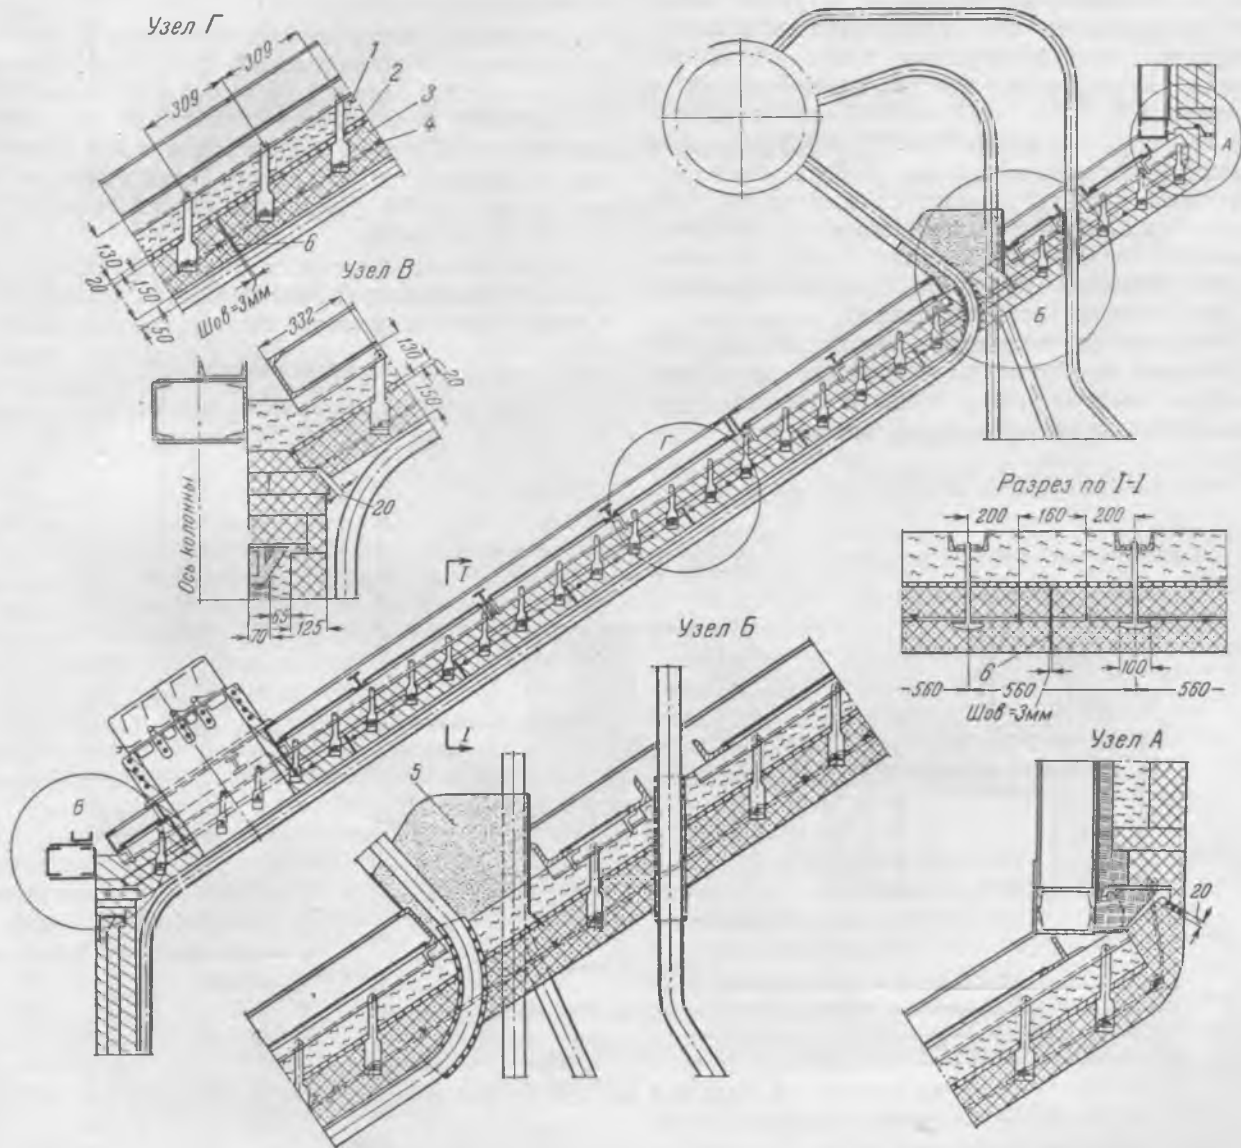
Наклонное перекрытие из огнеупорного бетона для котла ТП-230.
